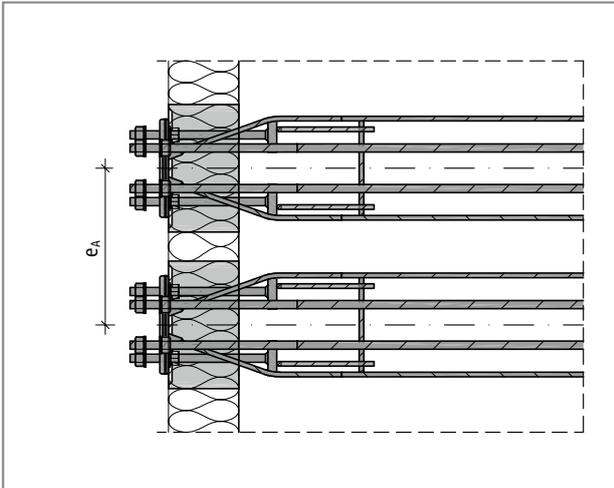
Schöck Isokorb® XT Typ SK: Achsabstand
